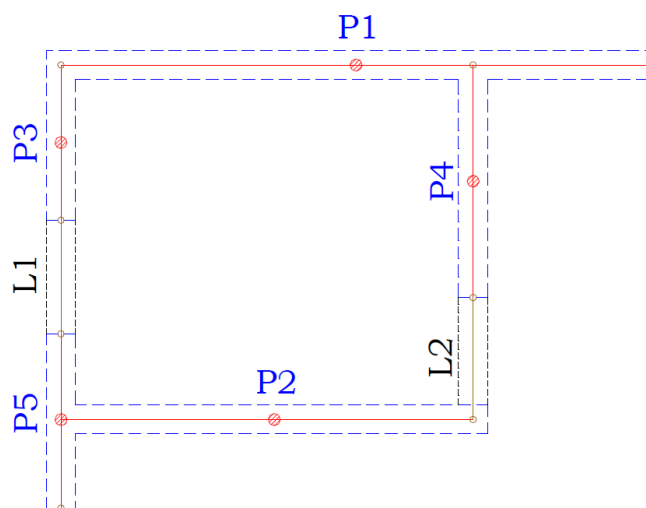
Planta baixa da modelagem tridimensional dos painéis de contraventamento com elementos de barra. Fonte: Nascimento Neto (1999).
